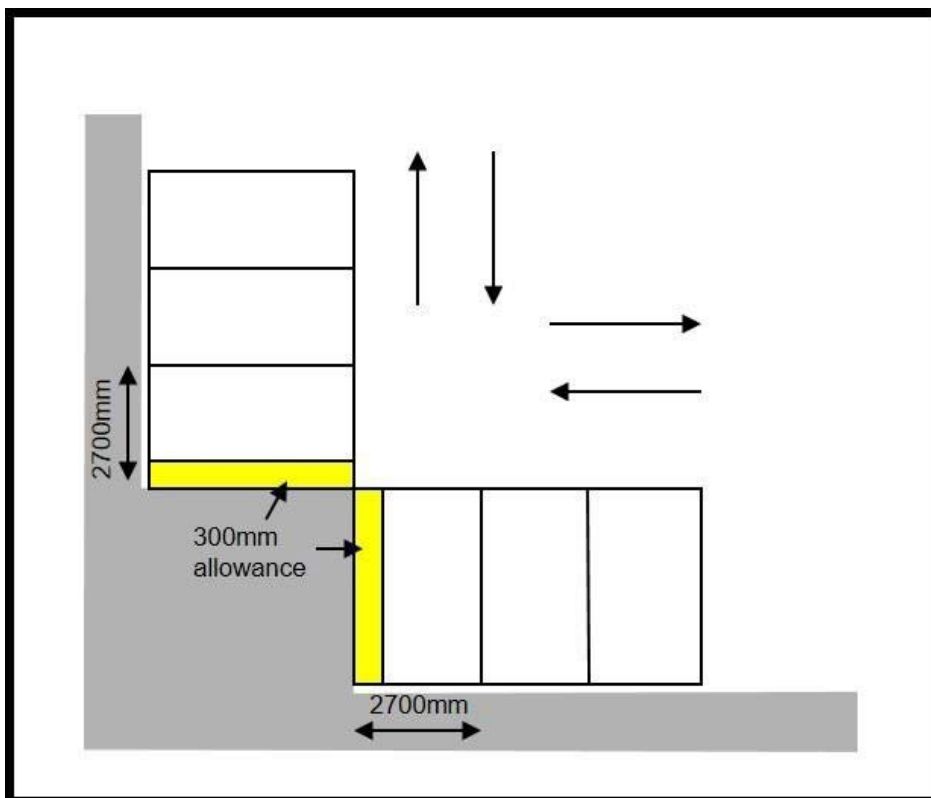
Схема фрагменту планування гаража план із збільшенням перпендикулярних паркомісць біля стіни
